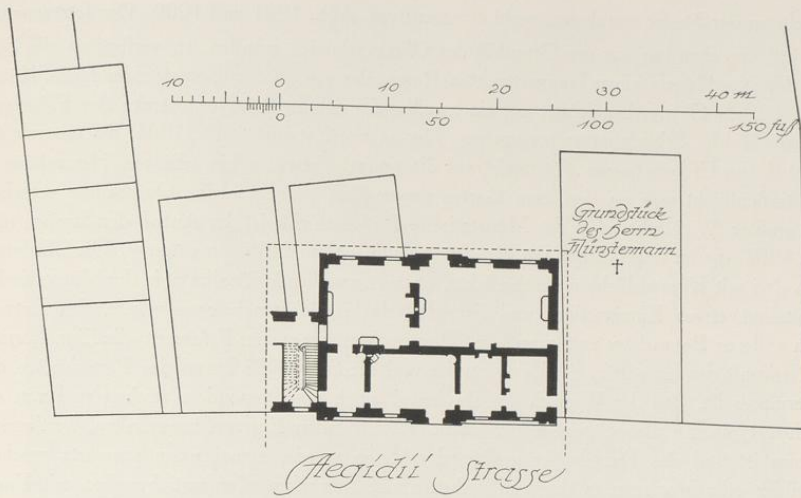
Grundriß des Erdgeschosses des Nordkirchener Hofes
